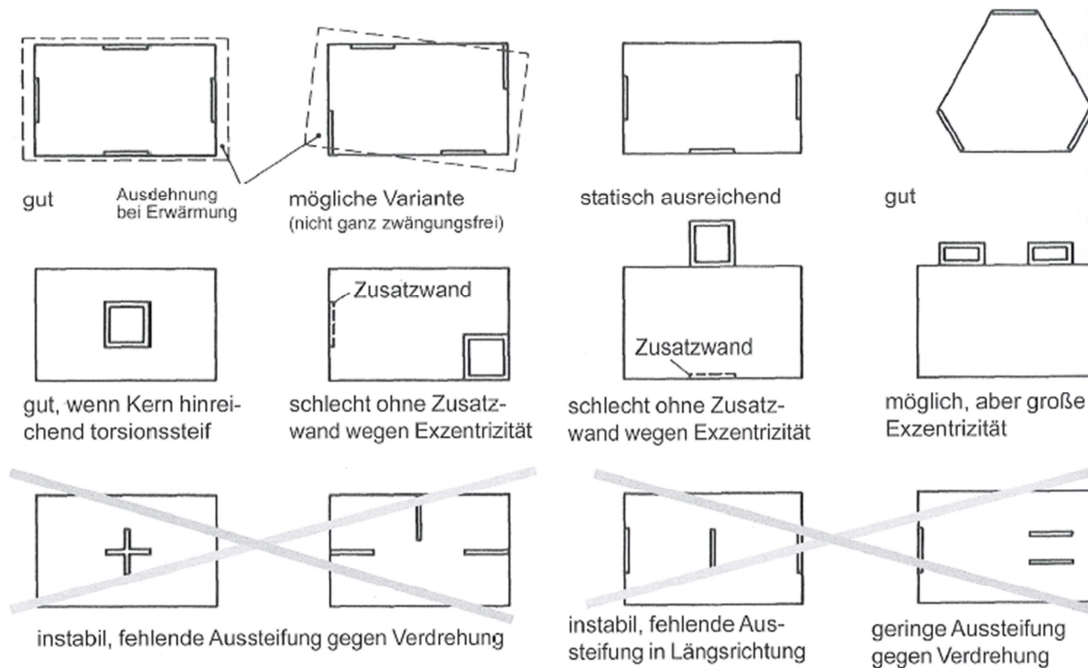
Anordnung der Tragwände im Grundriss aus [7]
